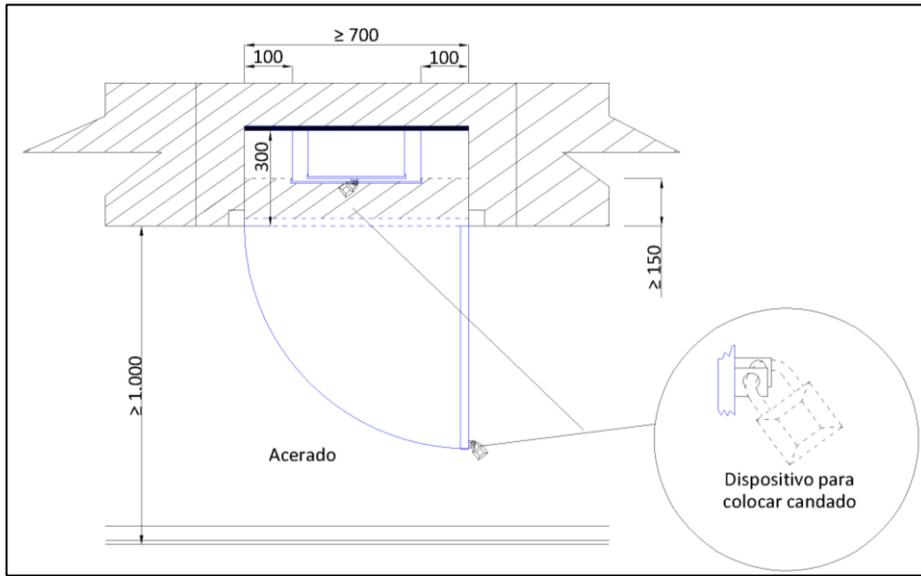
Instalación CGP y CS montaje vertical. Planta.
